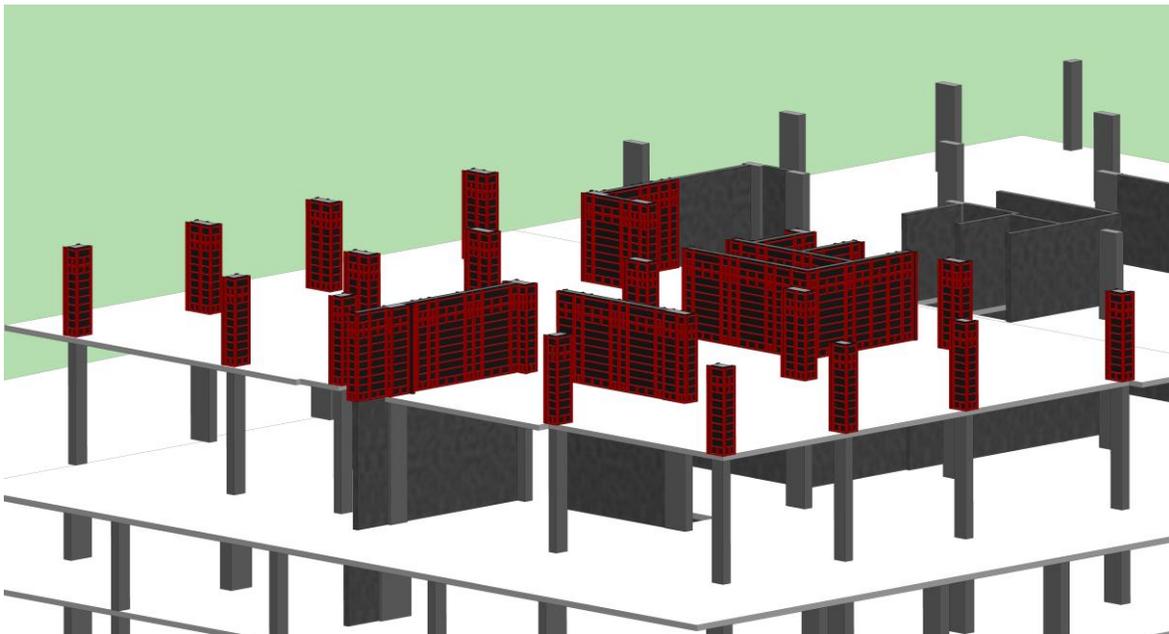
Vistas 3D de los encofrados para columnas y muros de la sección B del nivel 1
